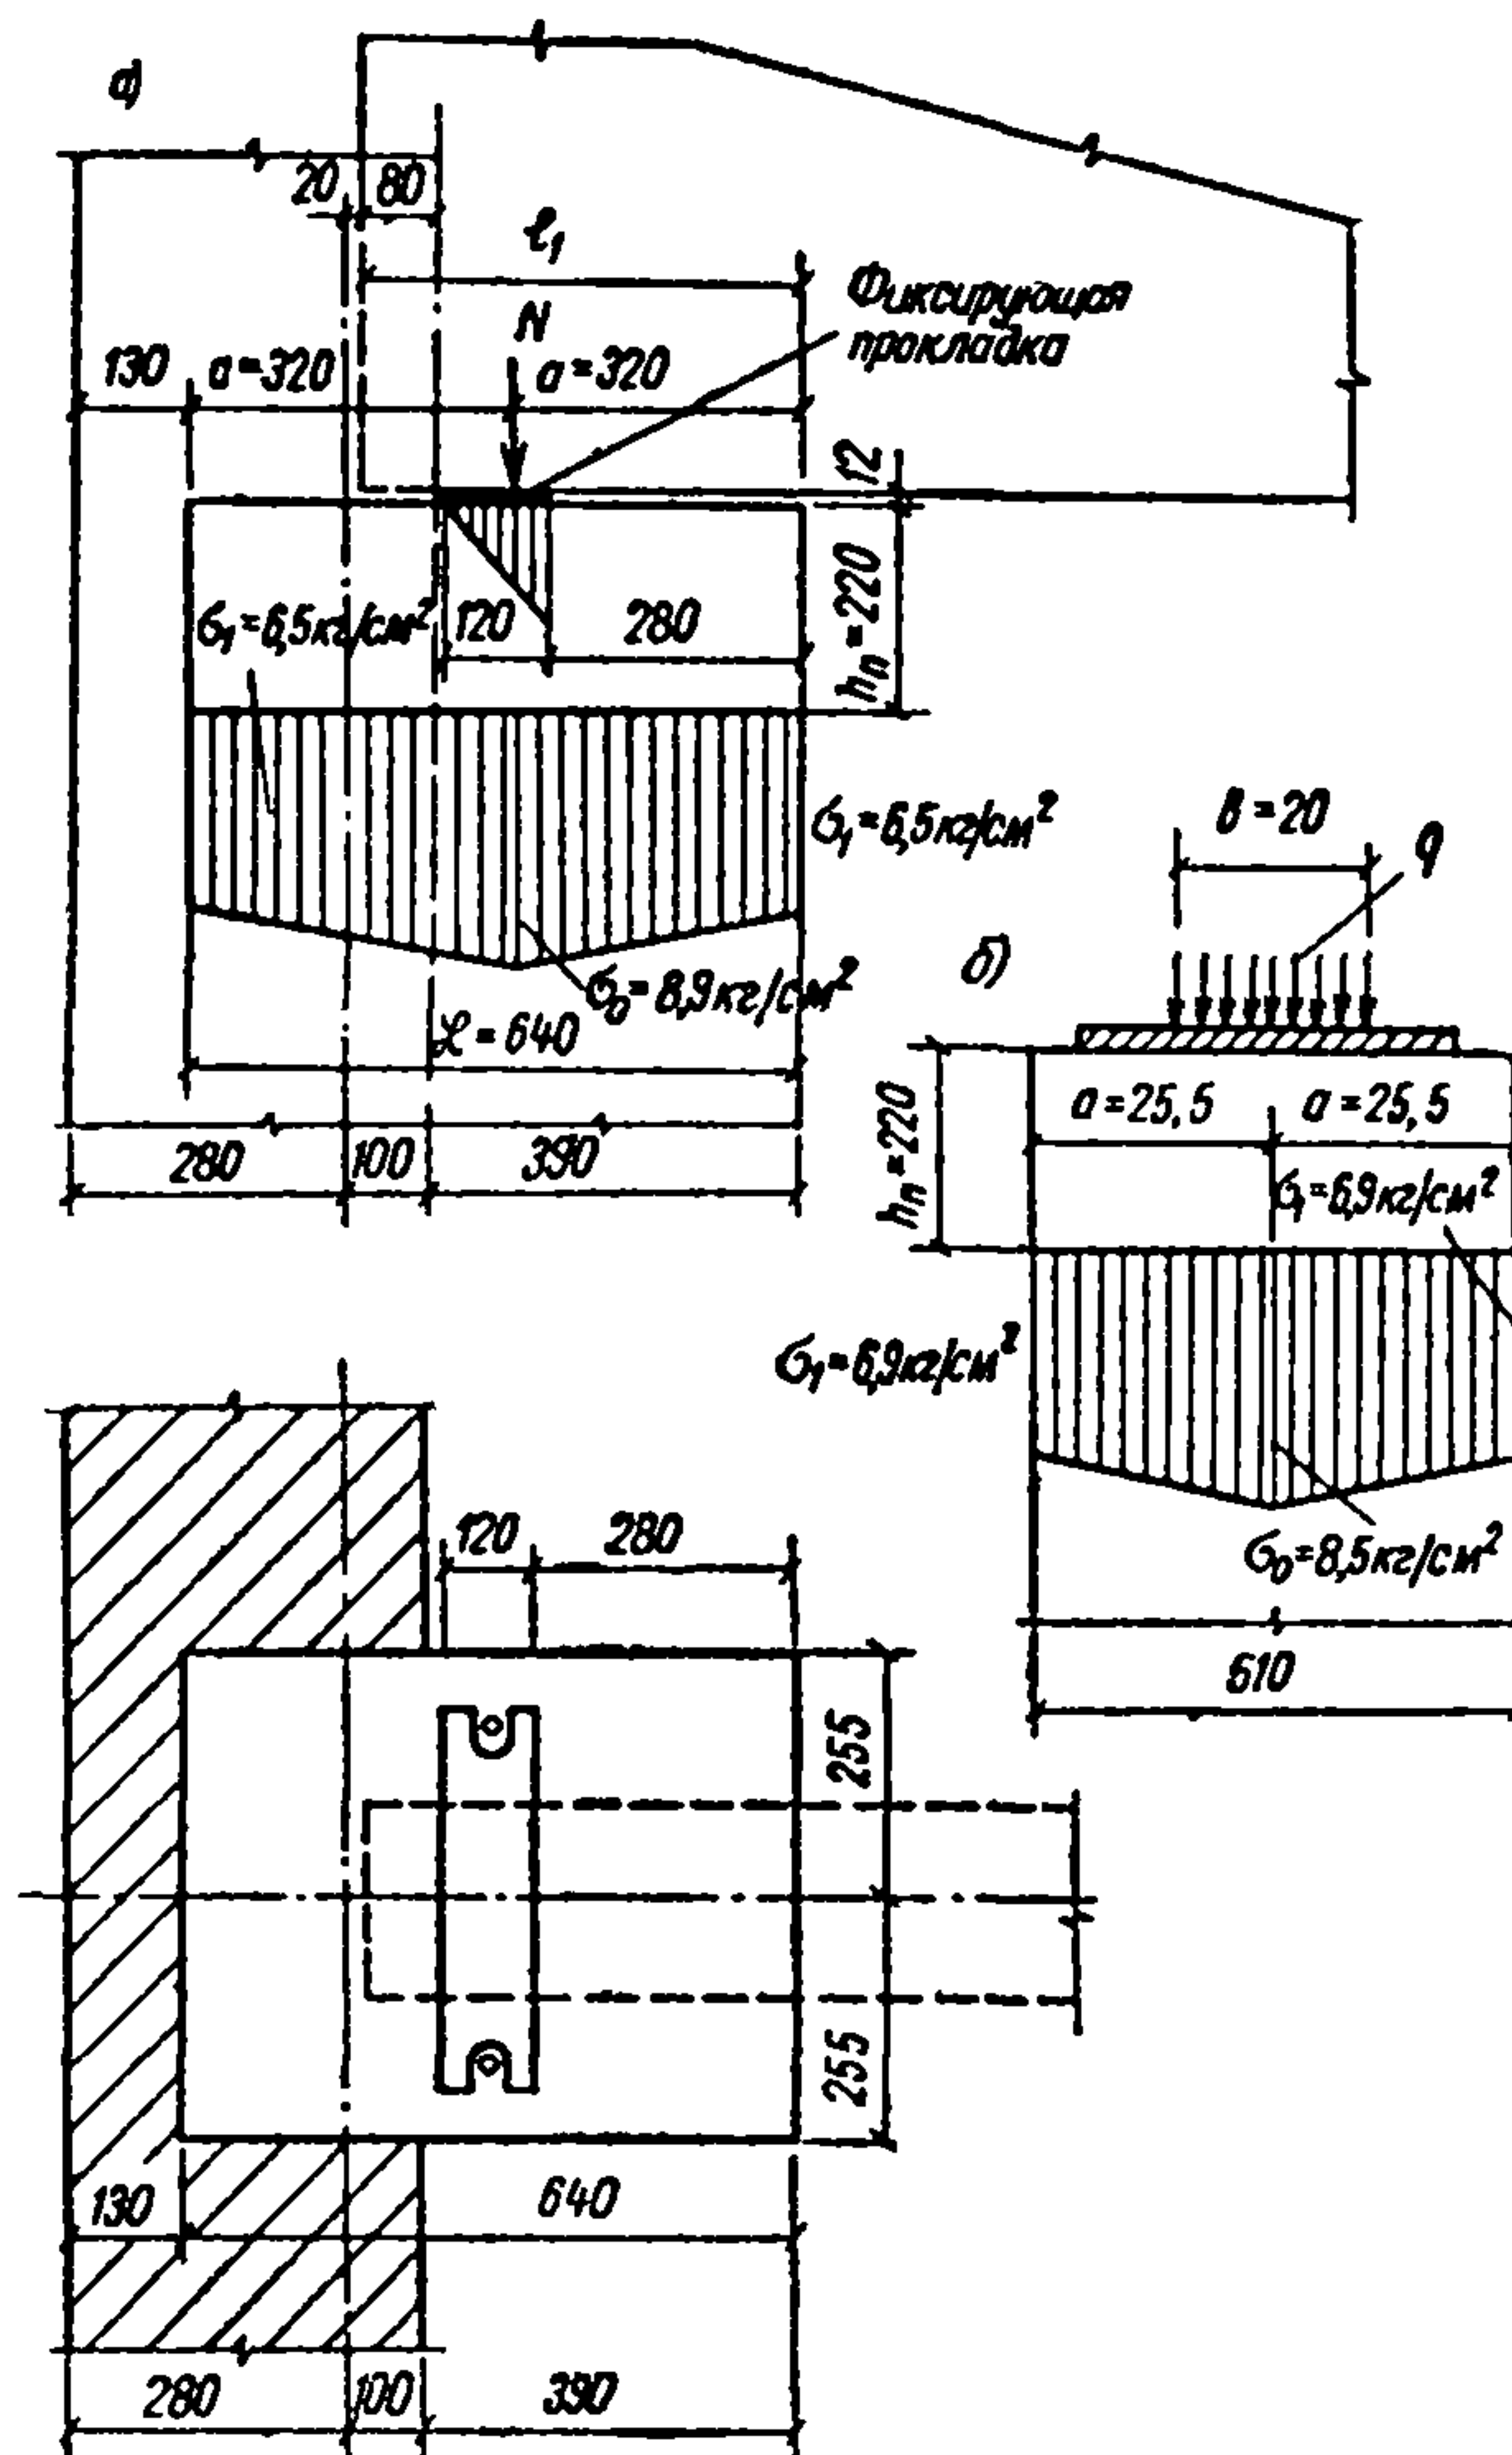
а — Схема узла опирания балки на стену с пилястрой и распределение напряжений в кладке под опорной плитой в направлении оси балки
